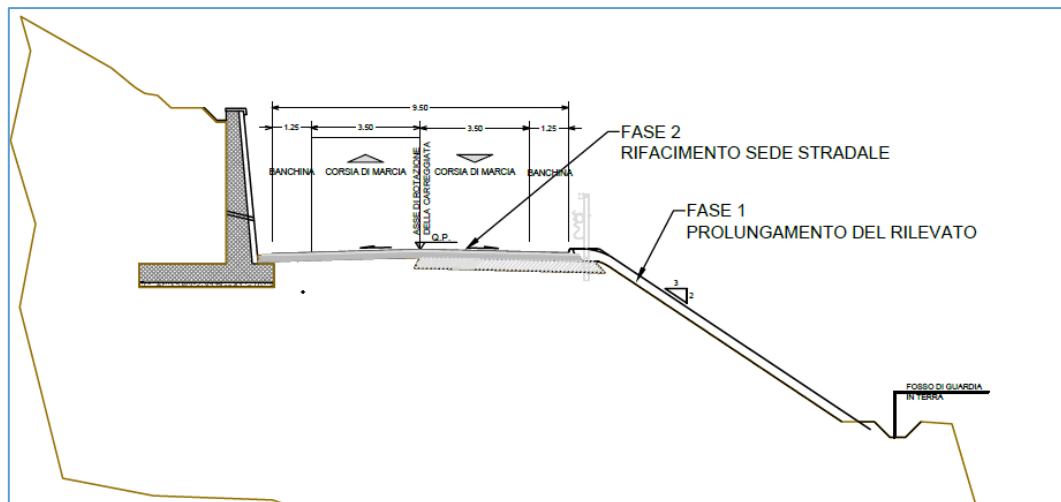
a – Sezione tipo 6 – Fase post operam
